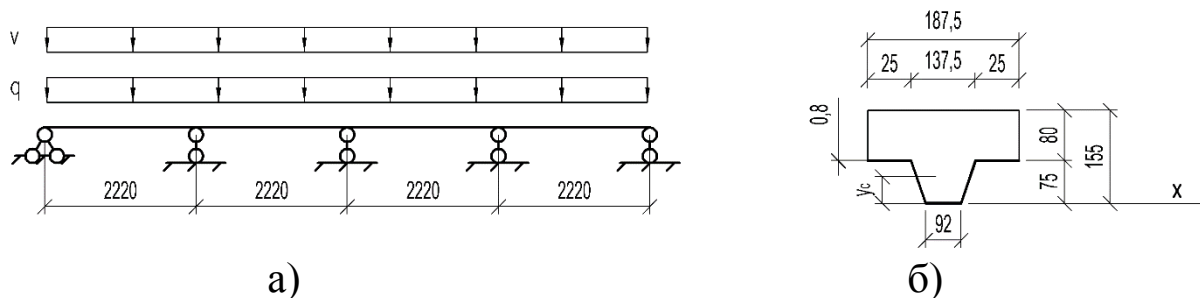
Расчетная схема монолитного перекрытия (а) и расчетное тавровое сечение (б)
